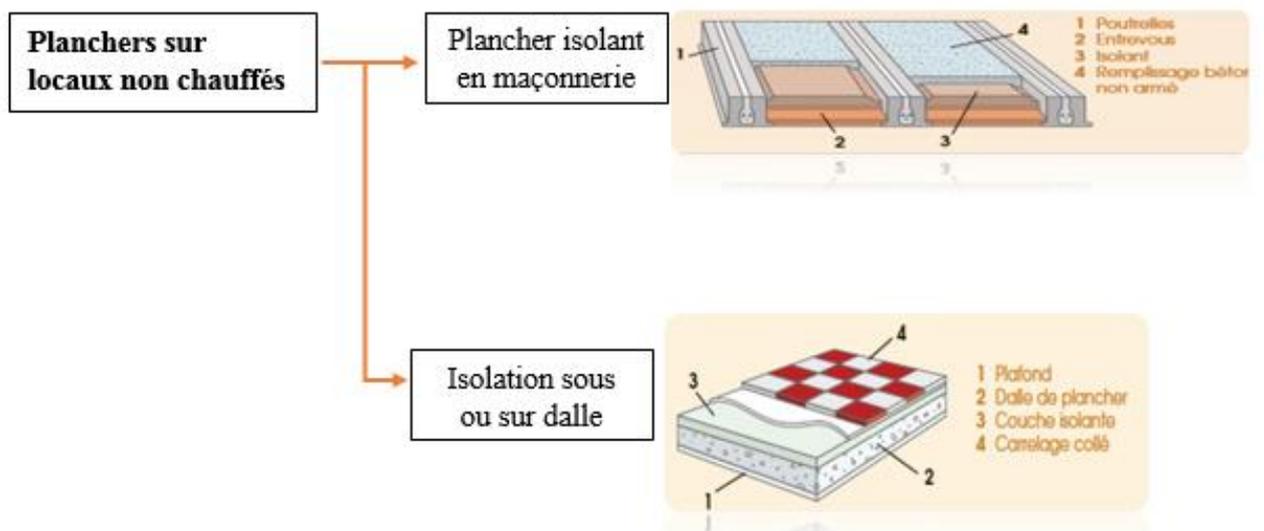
Isolation thermique des planchers sur locaux chauffés , source: par l'auteur
